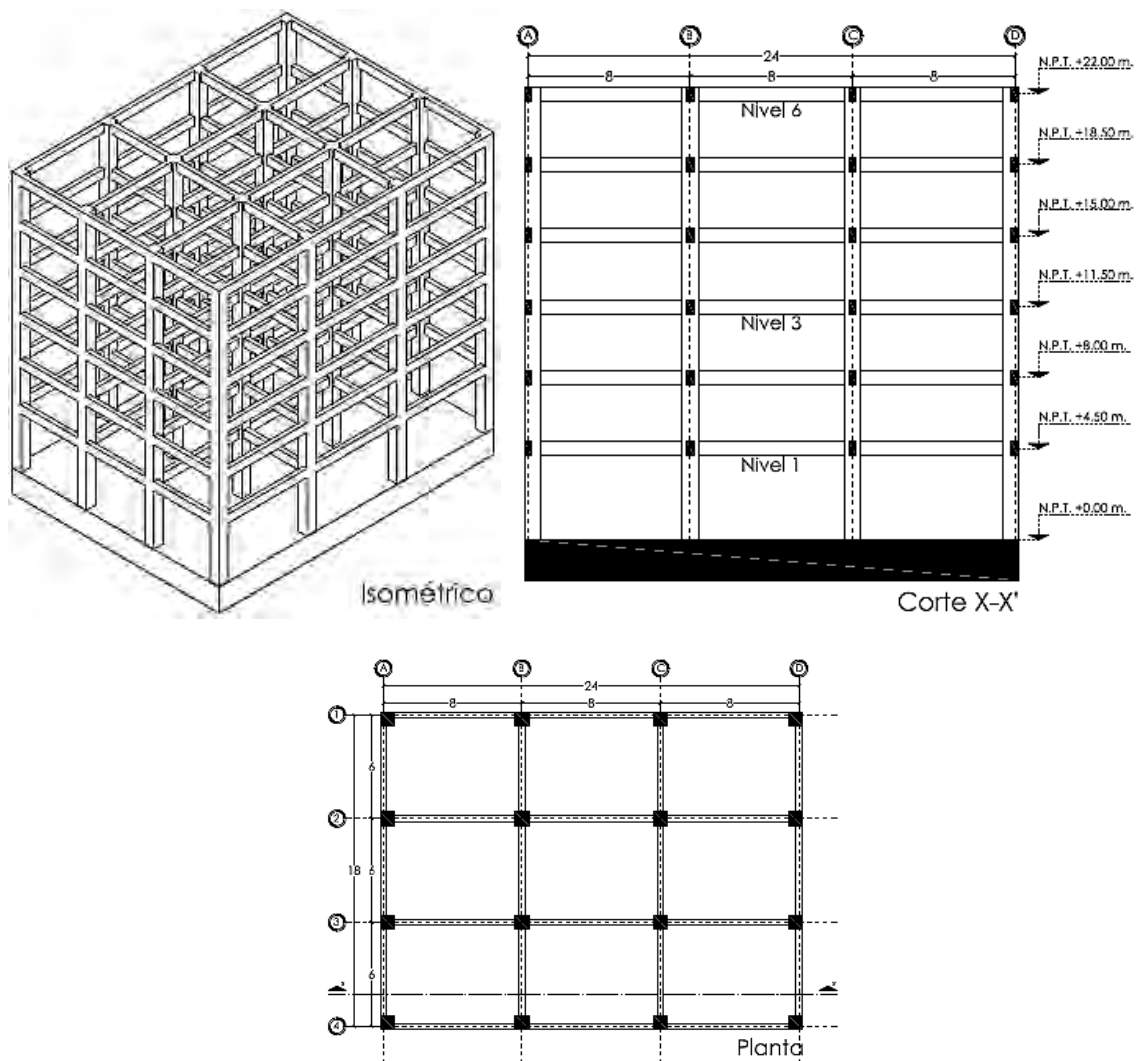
Marco de 6 niveles vista en (isométrico, corte y planta tipo).
